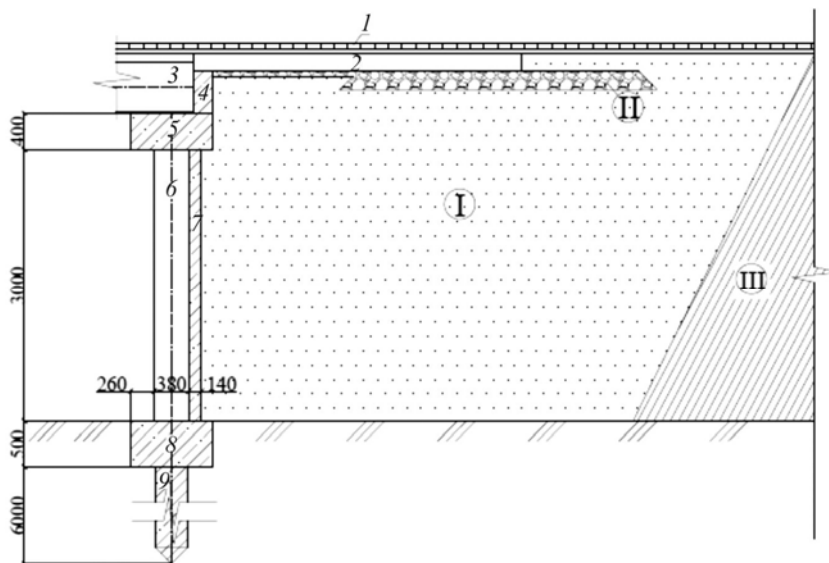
Конструкция армогрунтового устоя мостового перехода: 1 – покрытие автодороги; 2 – переходная плита; 3 – пролетное строение моста; 4 – шкафная стенка; 5 – ригель опоры; 6 – стойки опоры; 7 – плиты заборной стенки; 8 – ростверк свайного фундамента; 9 – свайный фундамент. (I – песок гравелистый; II – фракционный щебень; III – грунт земляного полотна)
